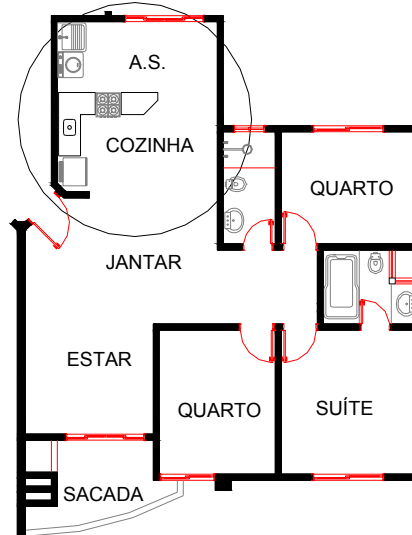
Planta Baixa dos apartamentos 301 e 402 - Estudo de caso D.
